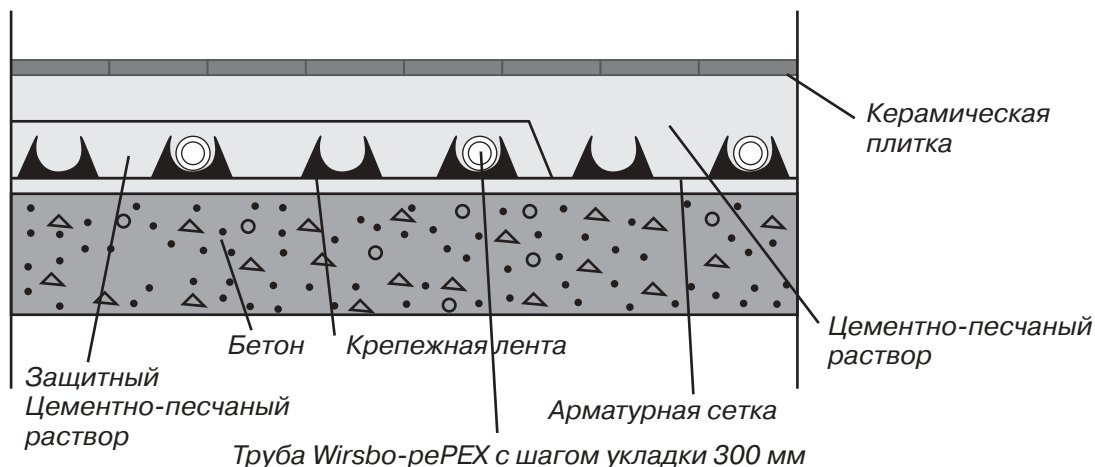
Наливной пол на бетонной плите. Петли трубы уложены на пластиковой крепежной ленте без зубцов.
